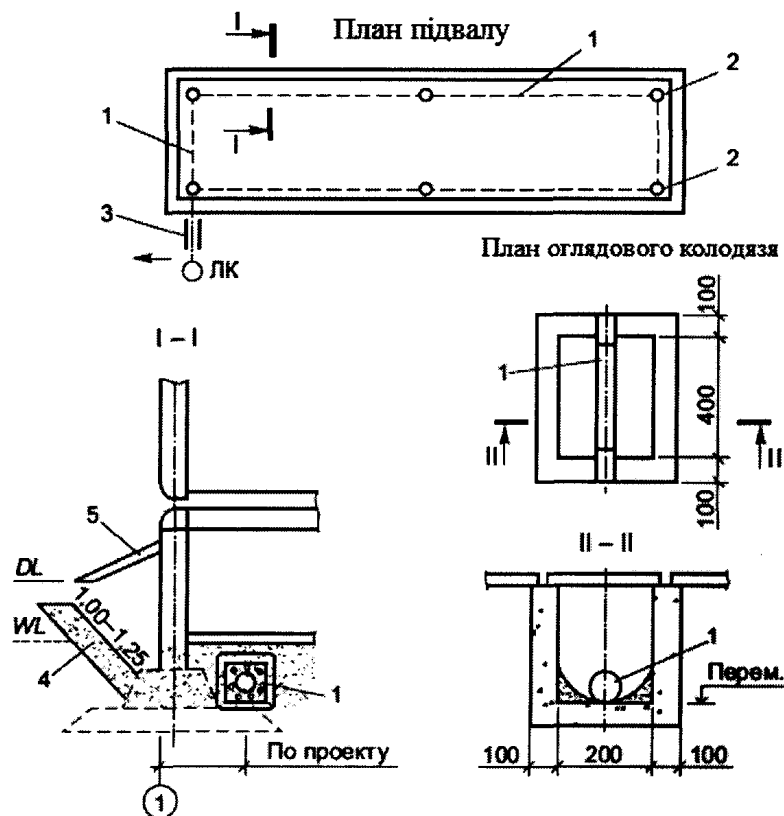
Схема конструкції пристінного дренажу з дренажно-ізоляційного геокмпозита
